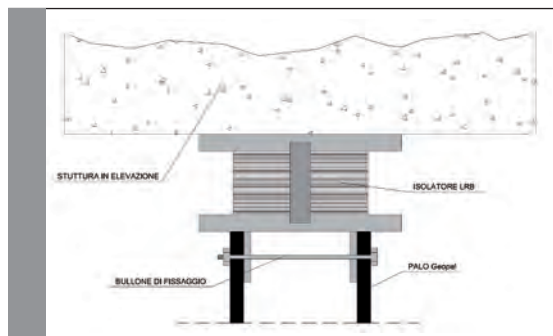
Collegamento di un palo fondazionale ad un isolatore tipo LRB.
